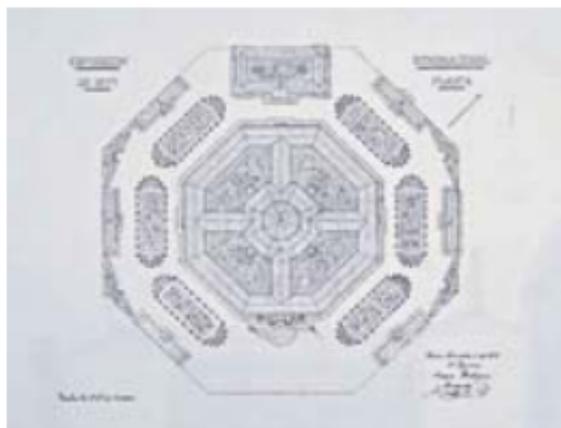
y 160. Proyecto del pabellón para la exposición internacional de 1880, Ing. Ramón Rodríguez Arangoiti. Fachada y planta
